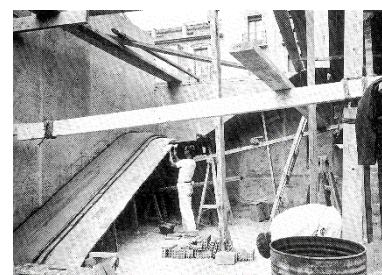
Ejecución de la escalera principal, Zaragoza, 1938.
